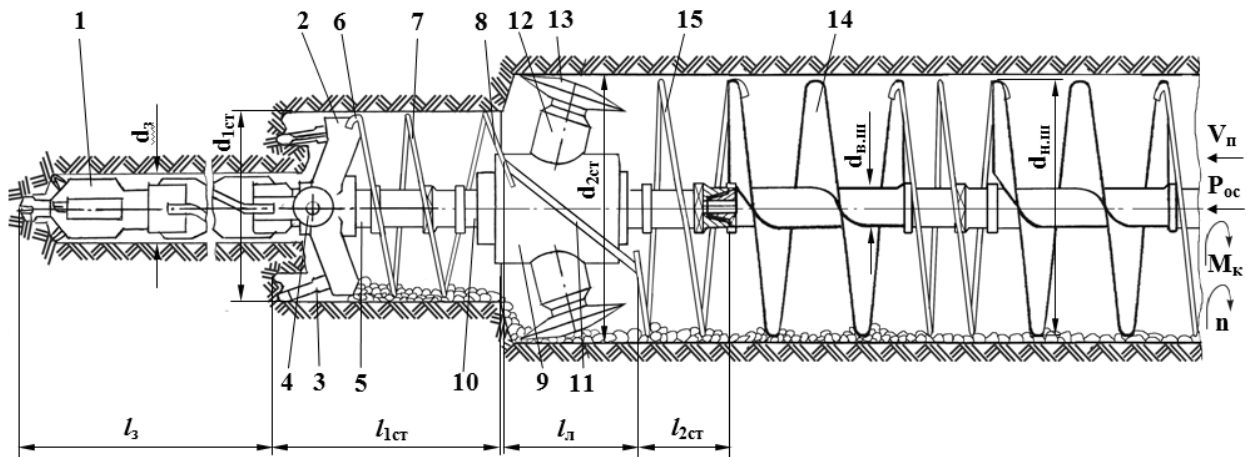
Компоновка расширителя прямого хода с двумя ступенями и пружинными винтовыми цилиндрическими спиралями
